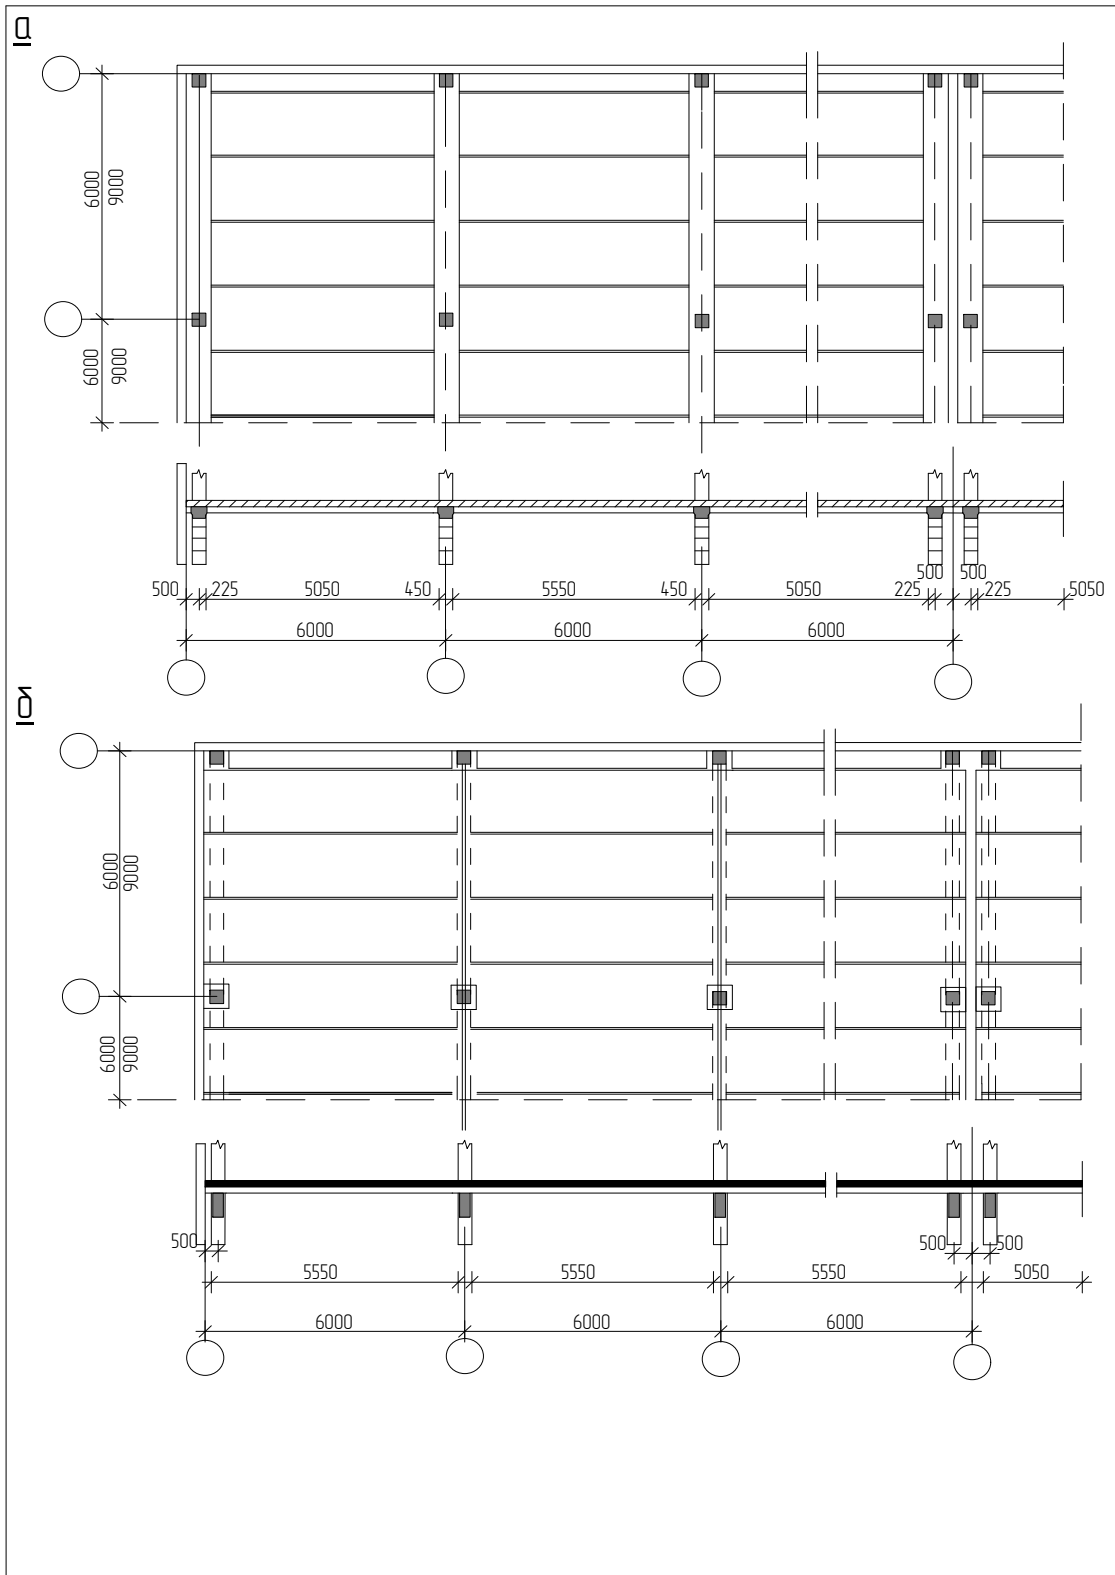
Схеми розкладки плит міжповерхових перекриттів багатопверхових промислових будівель; а – по ригелях з полицями; б – по прямокутних ригелях
